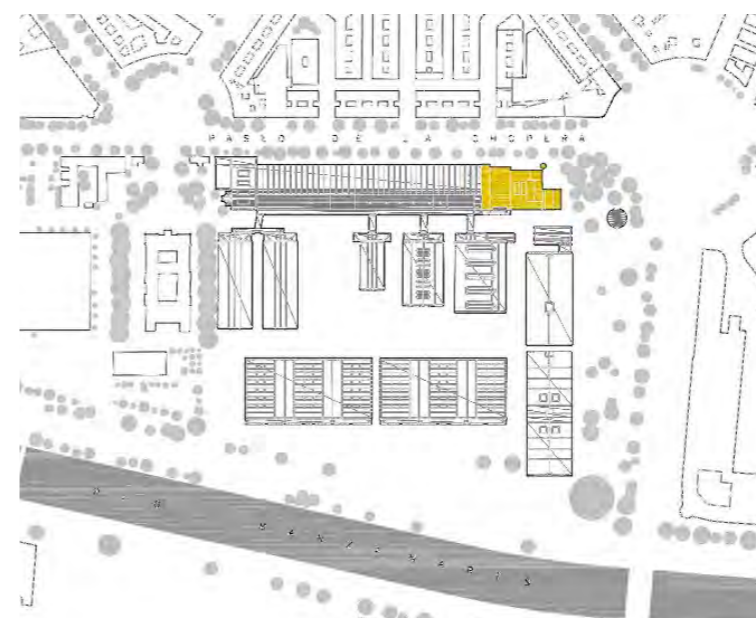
Localização do Pavilhão 17 - Cineteca, demarcado em amarelo. O Pavilhão 17
